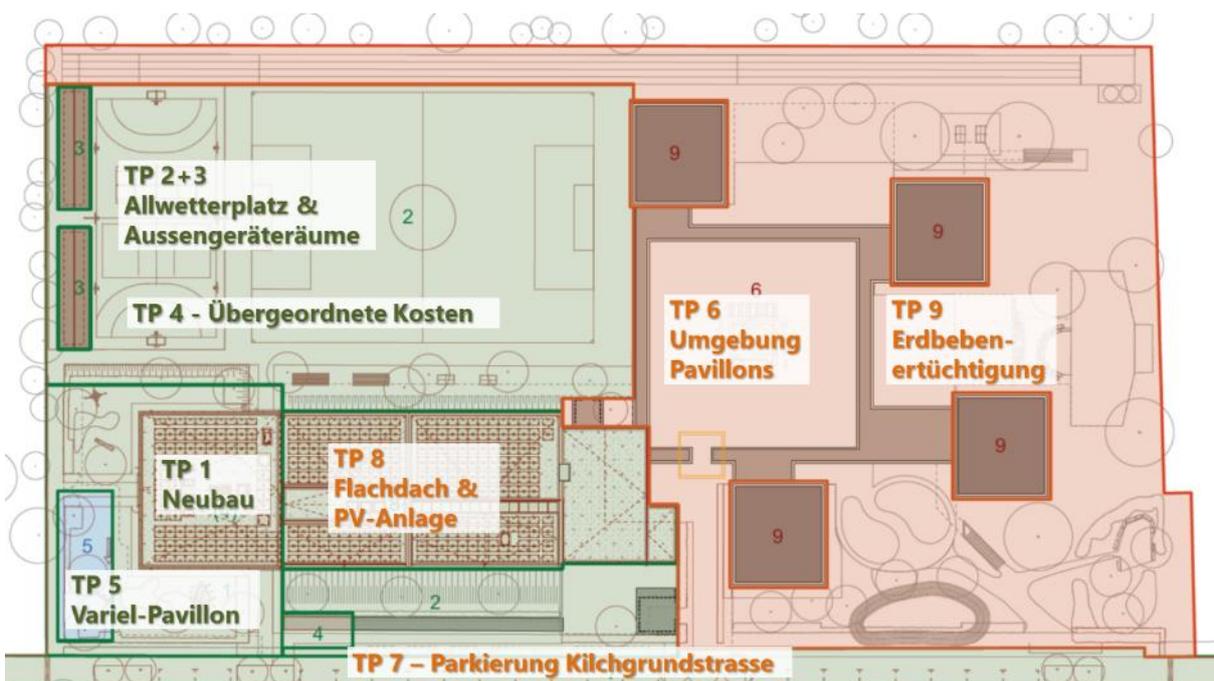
Übersichtsplan Gesamtplanung mit den verschiedenen Teilprojekten
